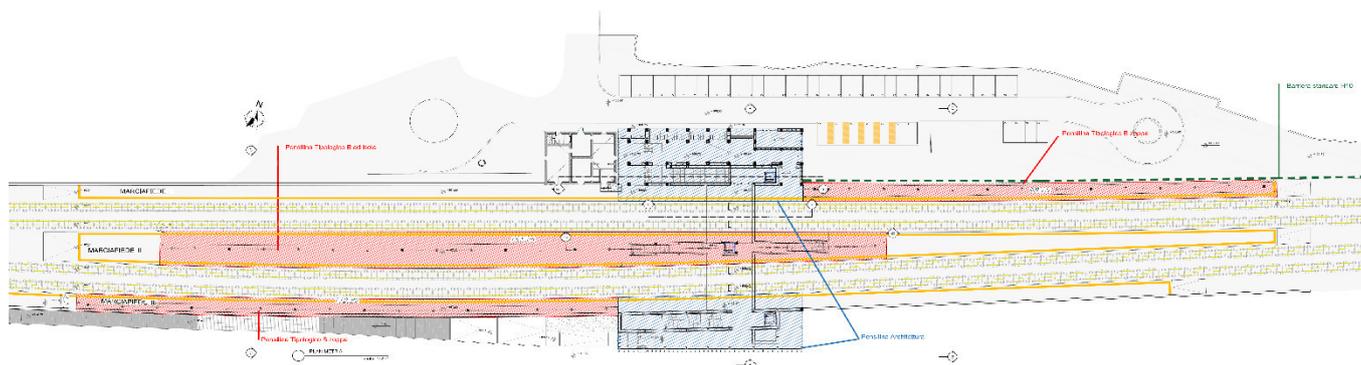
Planimetria di Inquadramento Stazione di Anguillara
